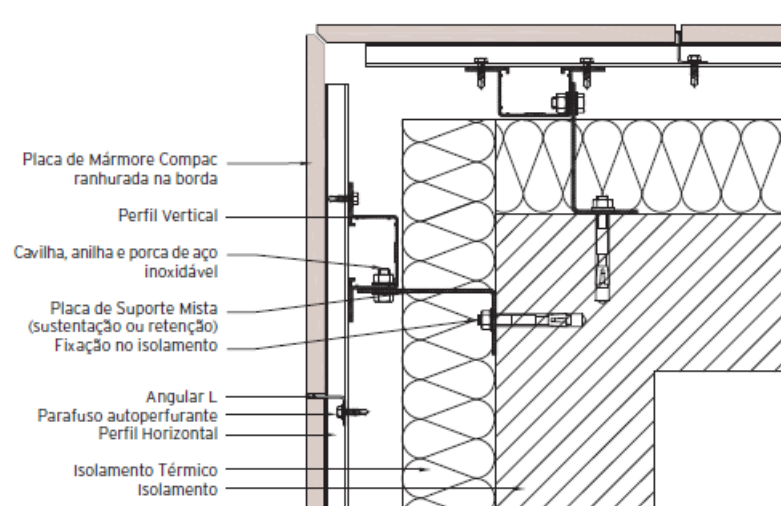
Detalhe construtivo de pormenor de aresta [79].
